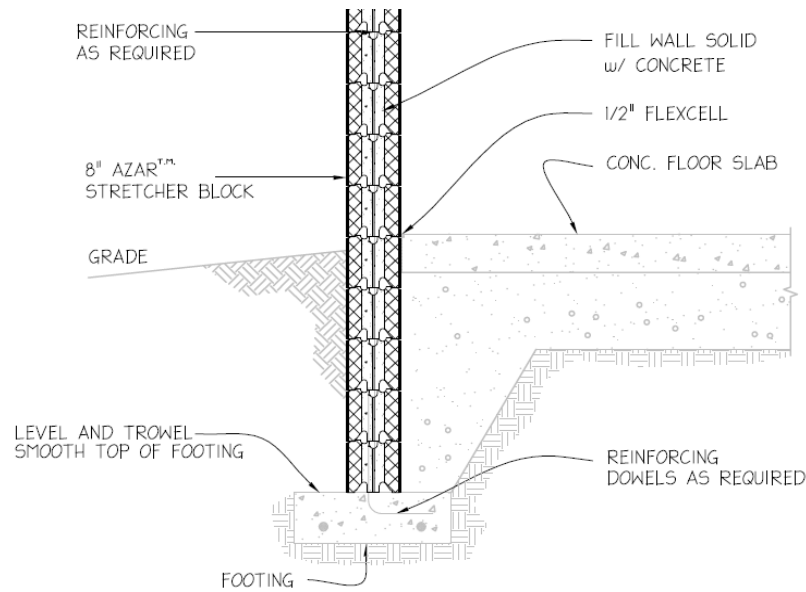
Sección tipo de muro de bloque macizado Azar block.
